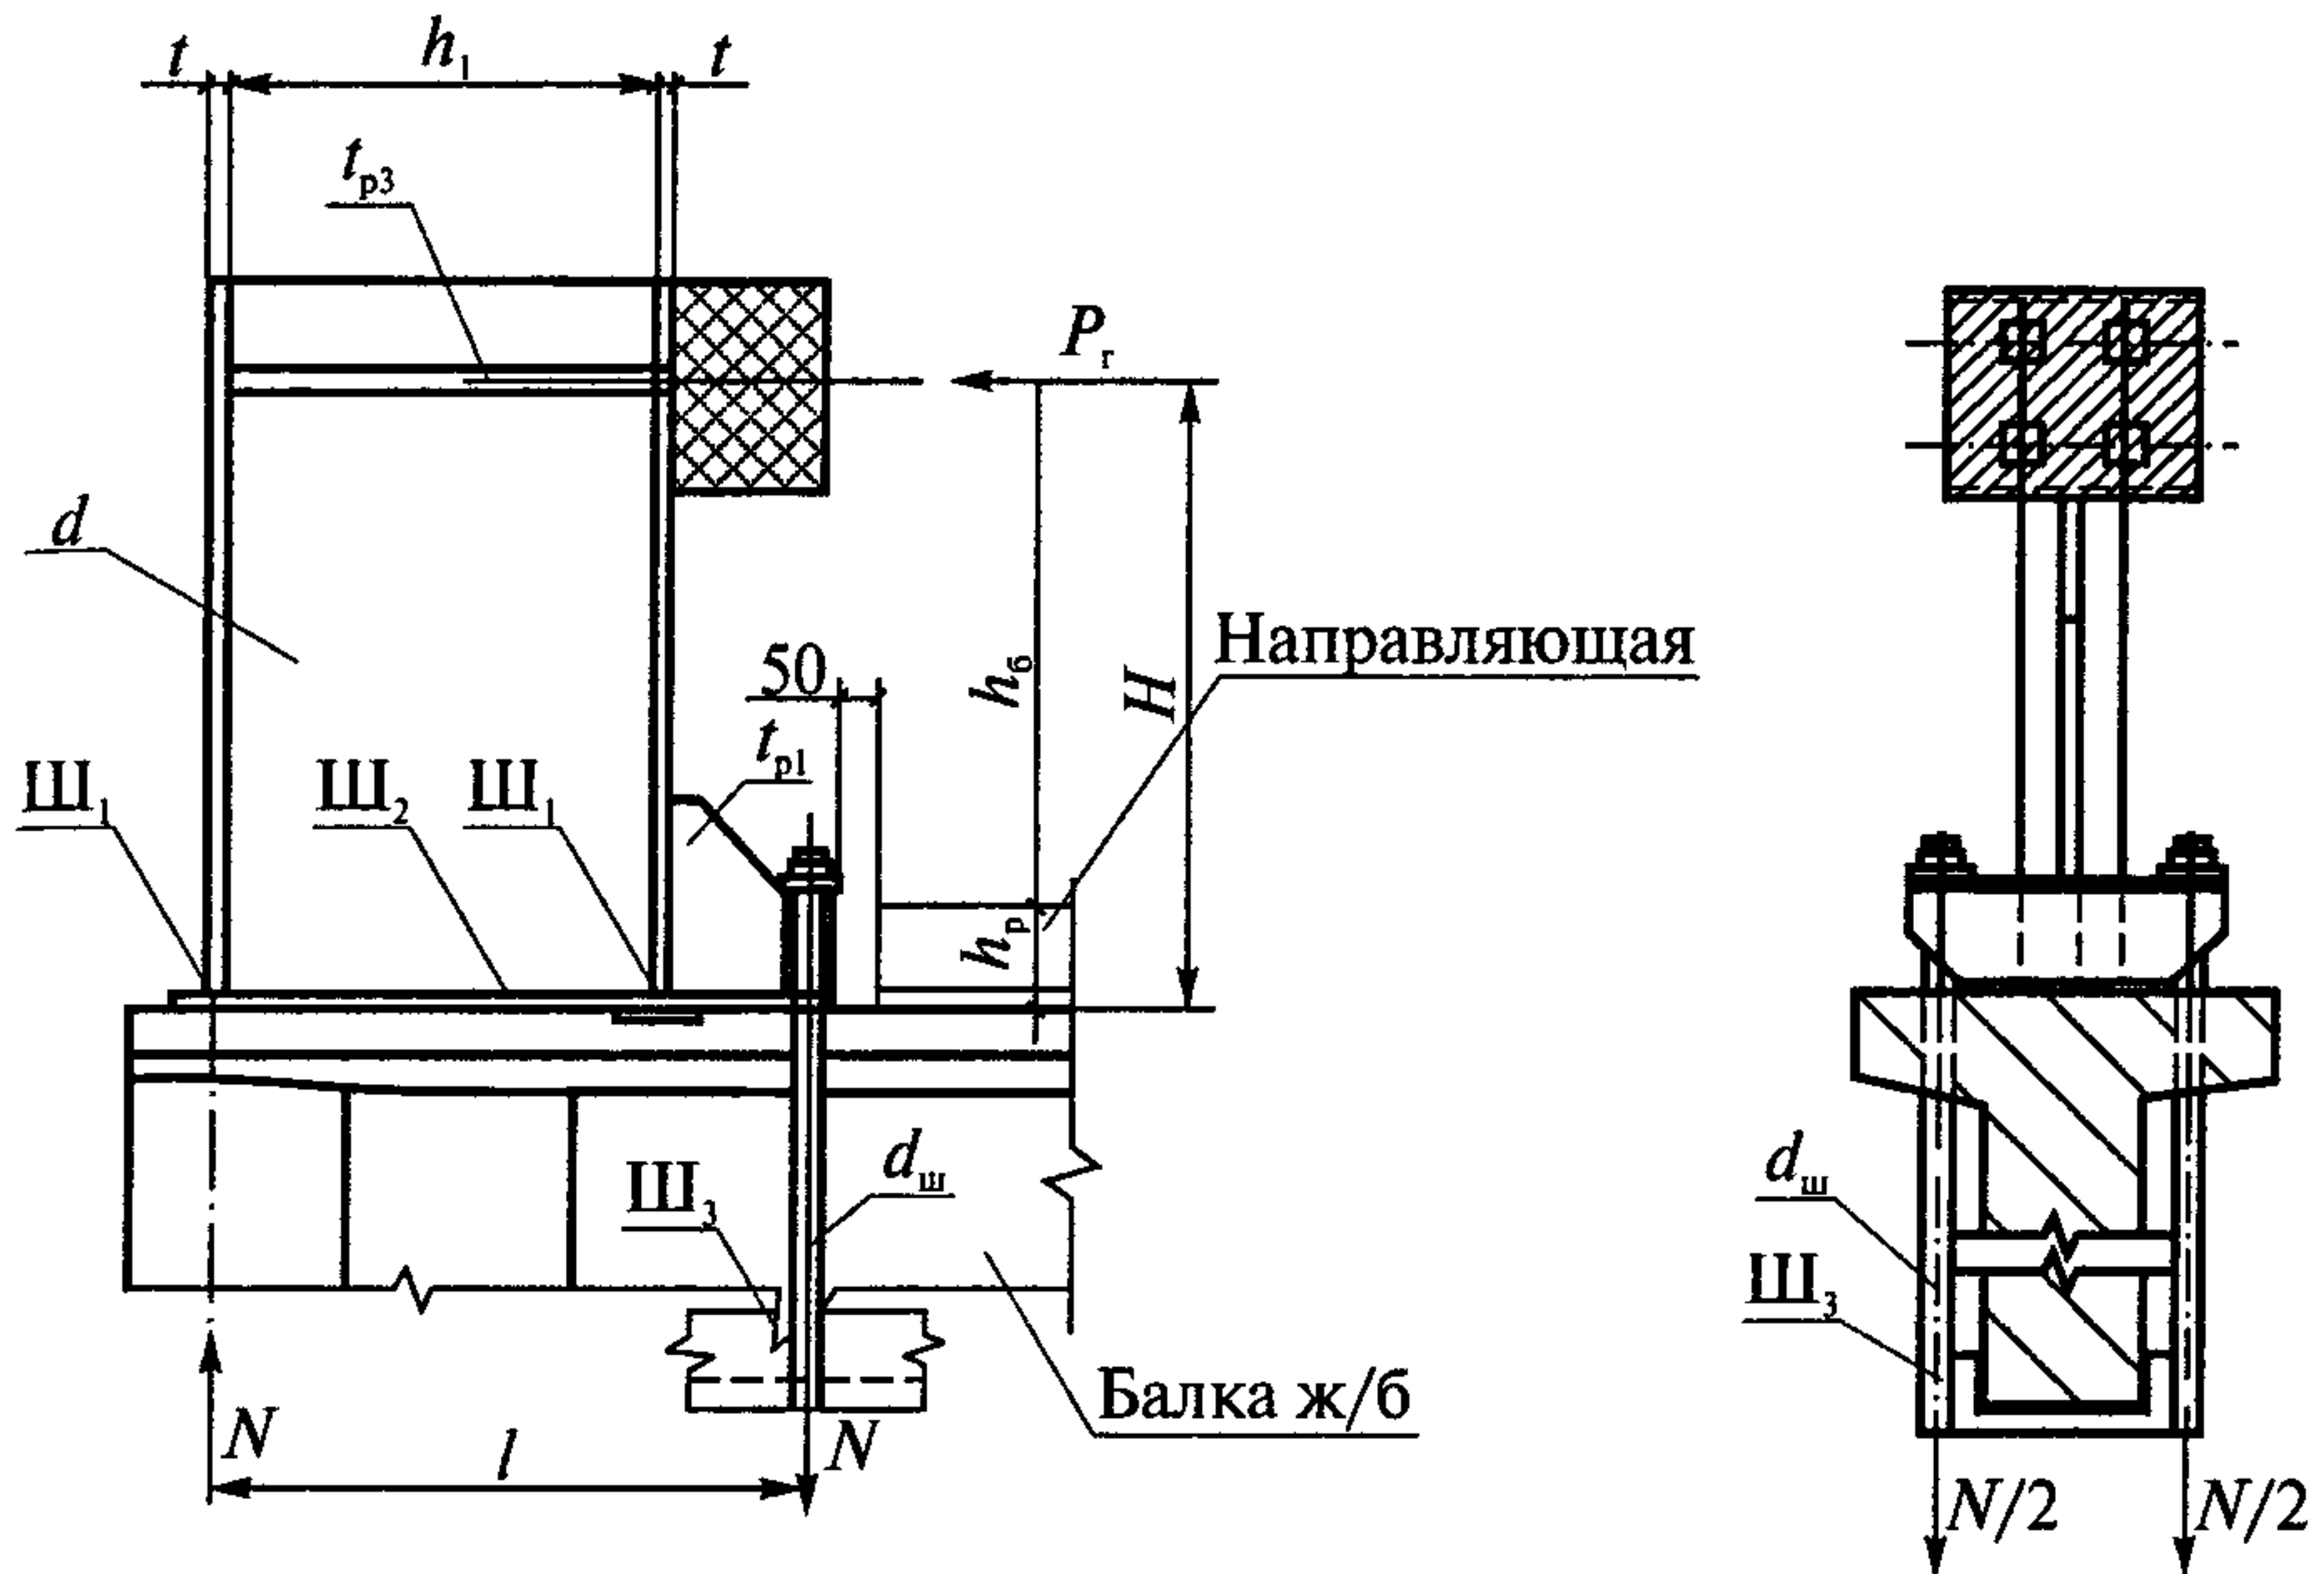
Расчетная схема тупикового упора на железобетонной балке:
